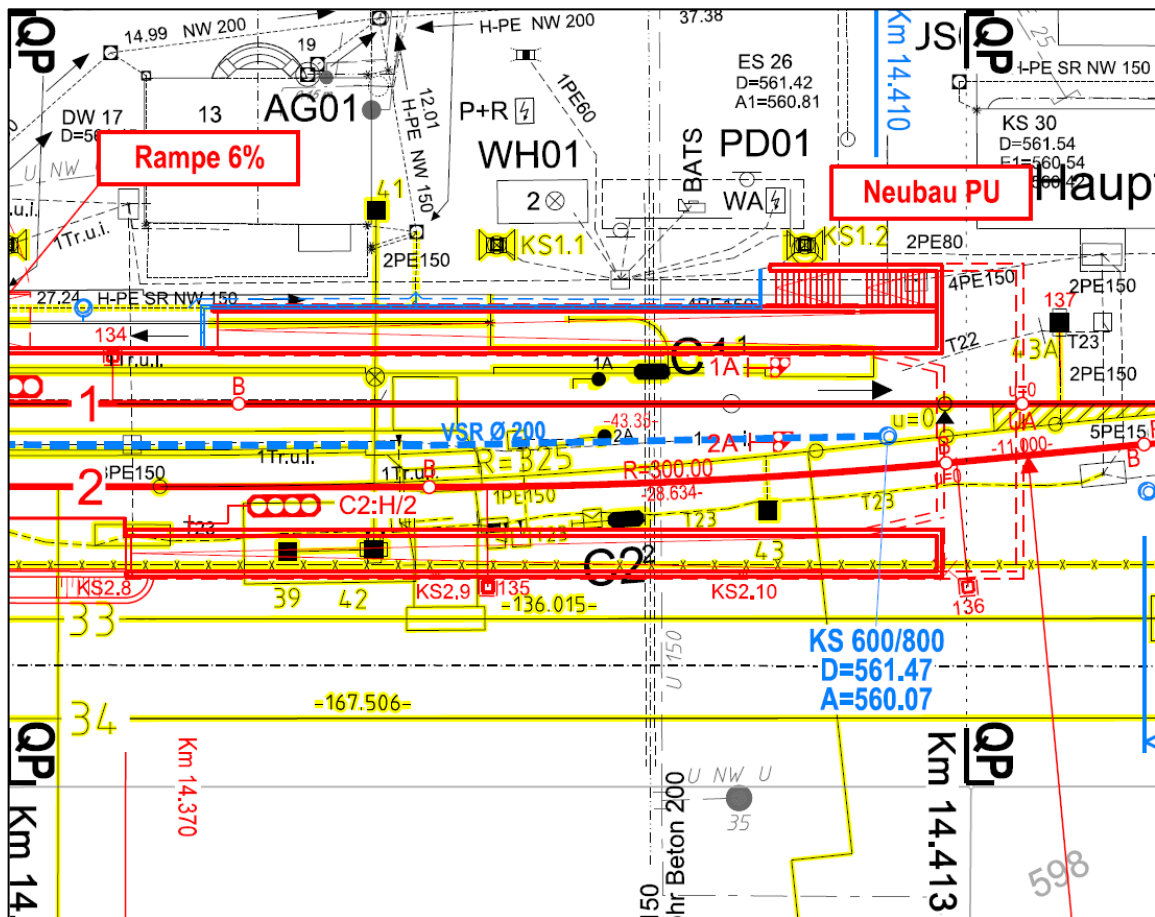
Zoom in Koordinationsplan aus dem Auflagenprojekt «Hauptwil»
